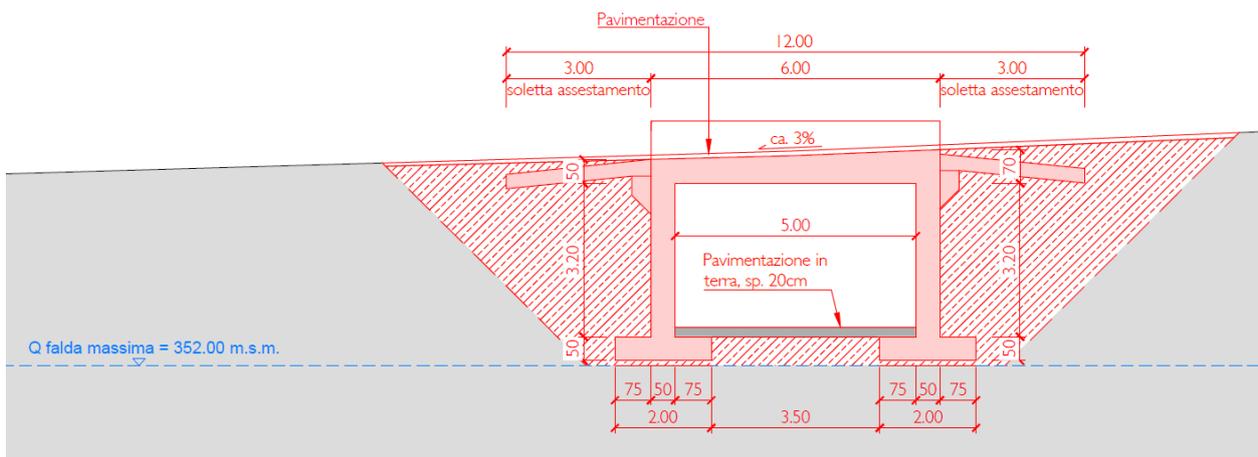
Nuovo passaggio faunistico zona Malvaglia – sezione trasversale
